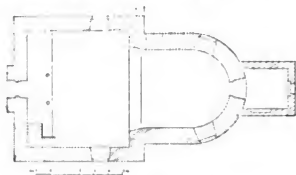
Gross-Hraschtitz. Grundriss der Kirche.
